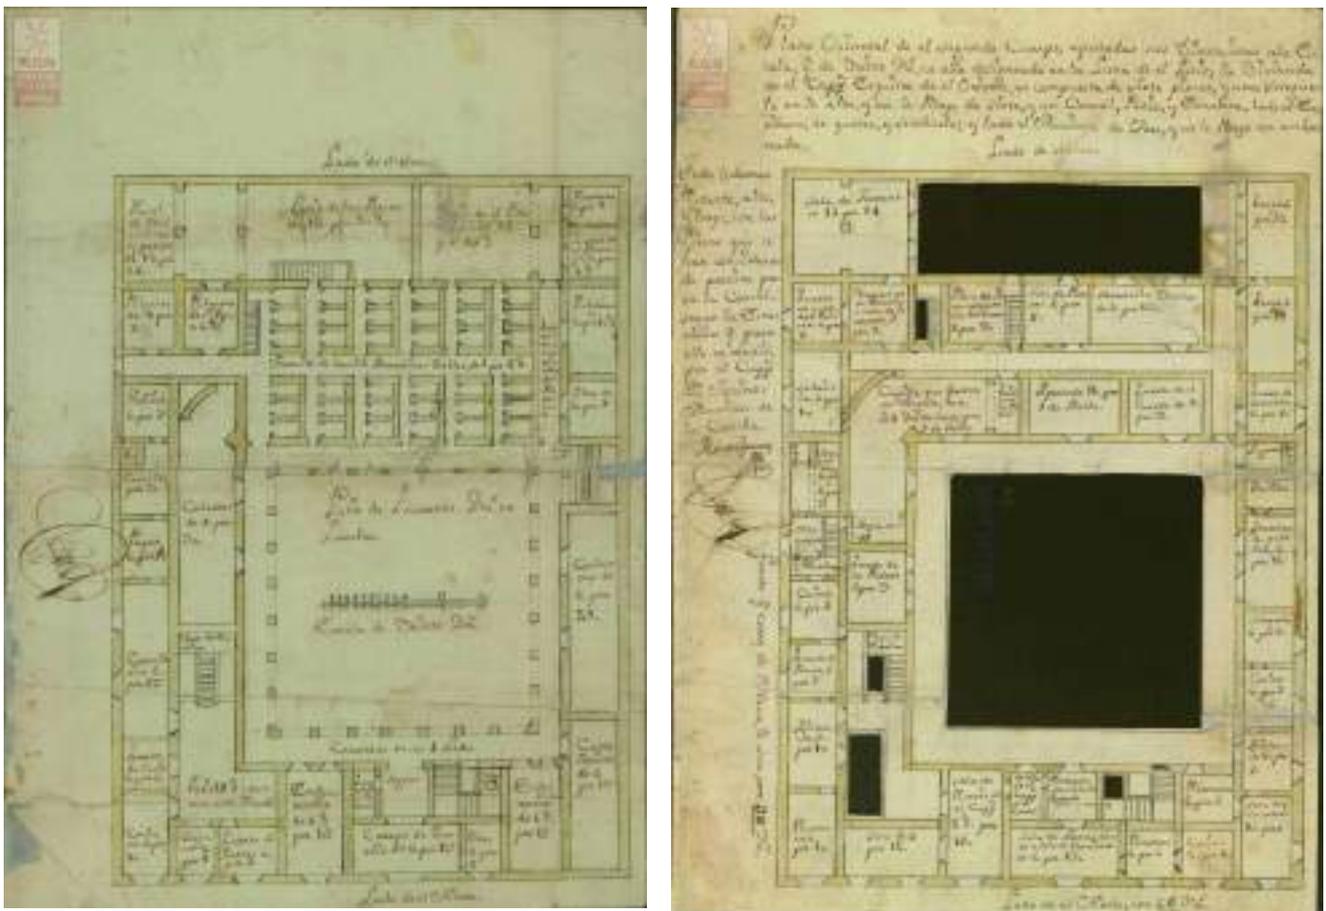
y 170. Lorenzo Rodríguez. Plantas arquitectónicas de la Cárcel de La Acordada con las ampliaciones de su reconstrucción. 1759. Archivo General de la Nación de México.
